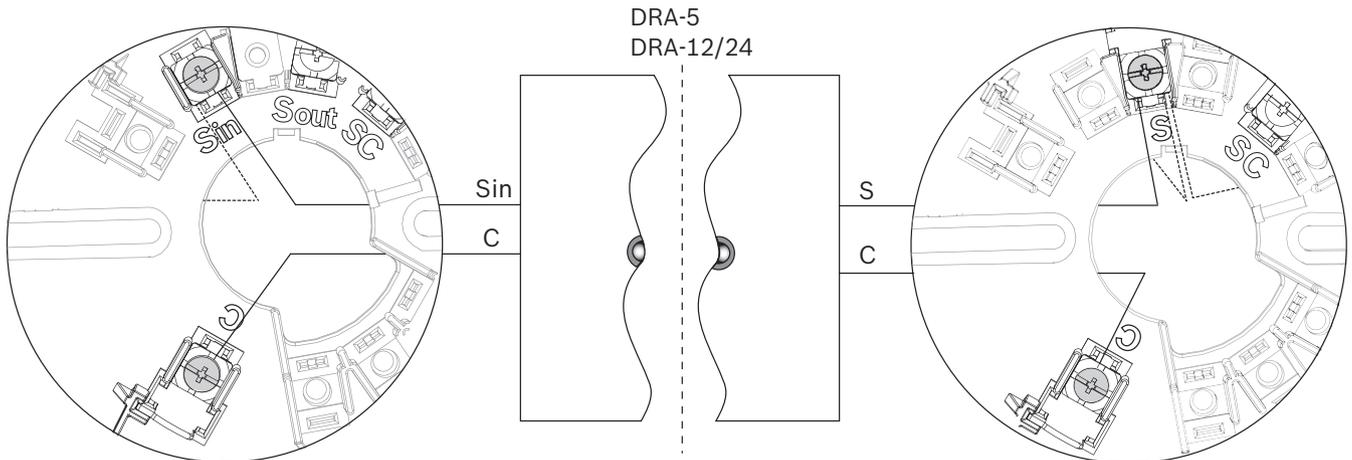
Cableado del anunciador remoto opcional, base aisladora (izquierda) y base estándar (derecha); Sin y S = cable rojo, C = cable blanco
